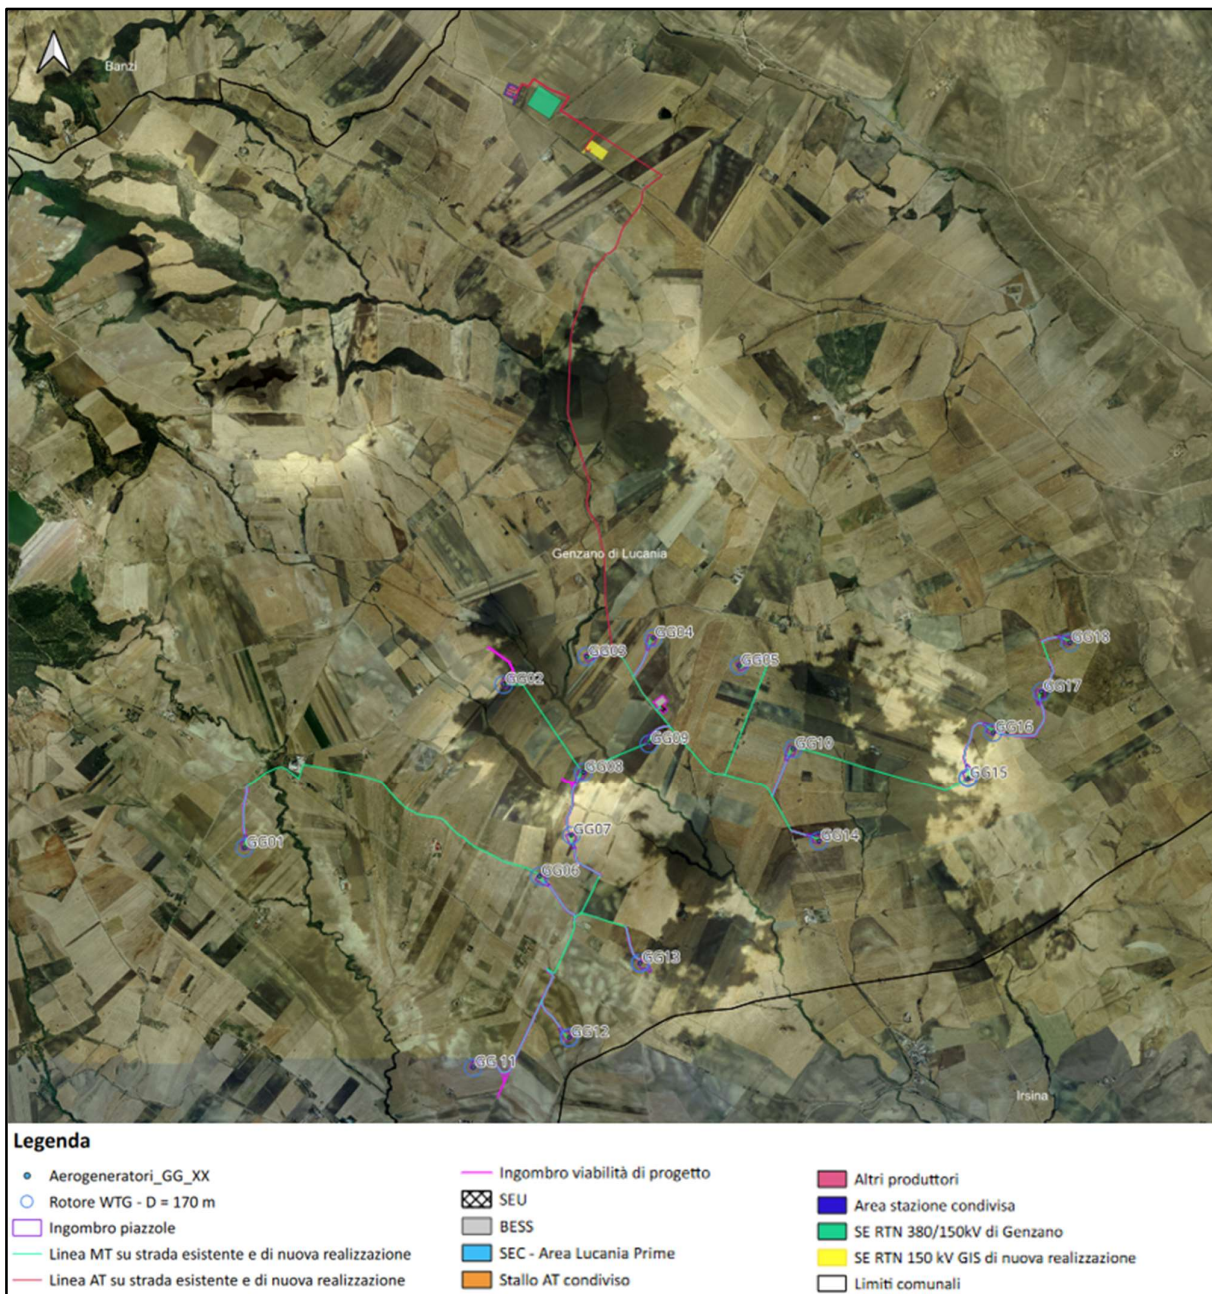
Layout d'impianto con viabilità di progetto su CTR
